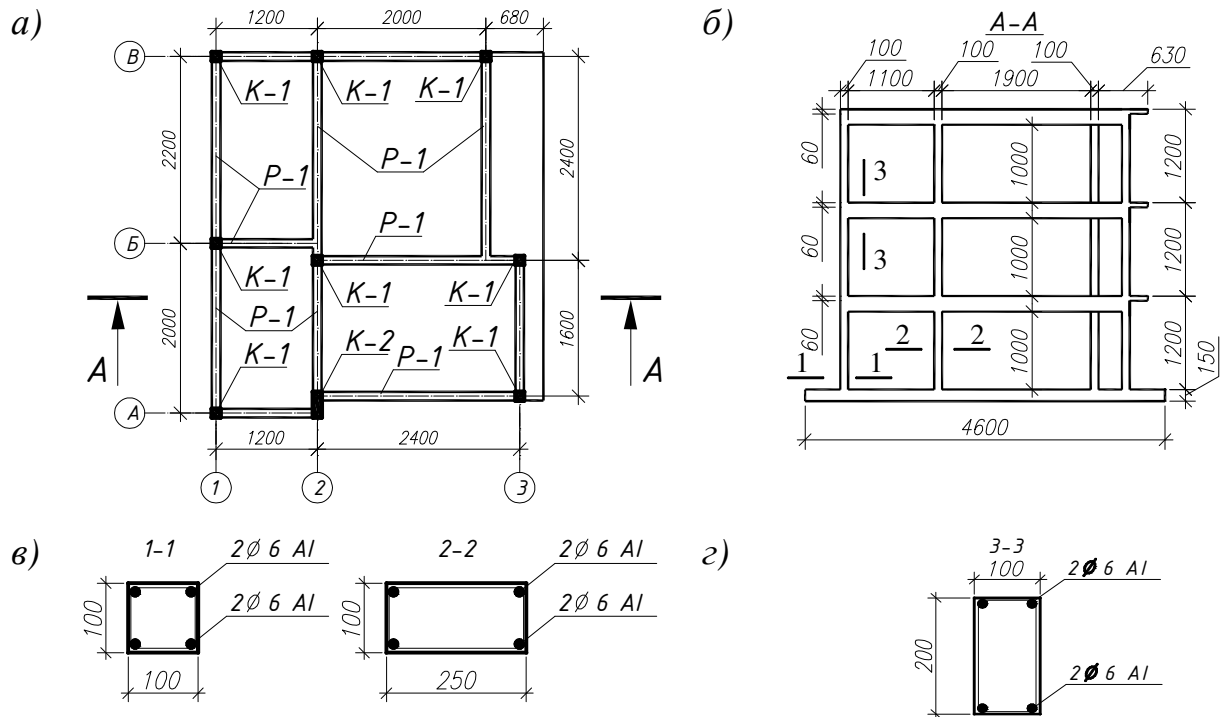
Конструкції експериментальної моделі: а – план; б– розріз; в – переріз колон К-1 і переріз колони К-2; г – переріз ригеля Р-1
